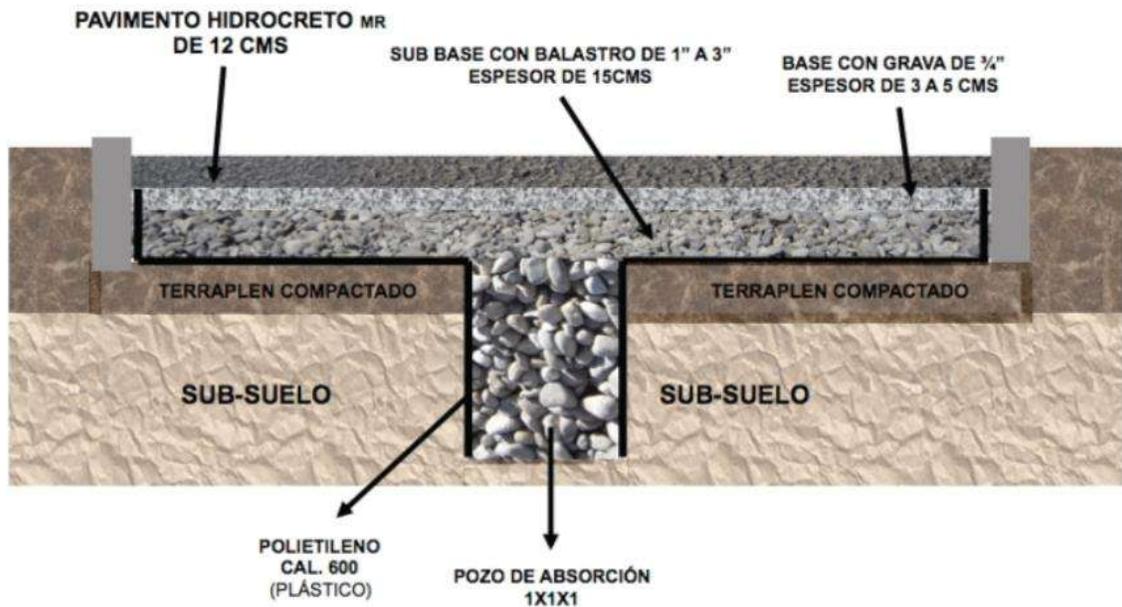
Elementos y proceso constructivo de un pavimento con concreto permeable (HIDROCRETO) Concreto Ecológico de Mexico SA. de CV.
